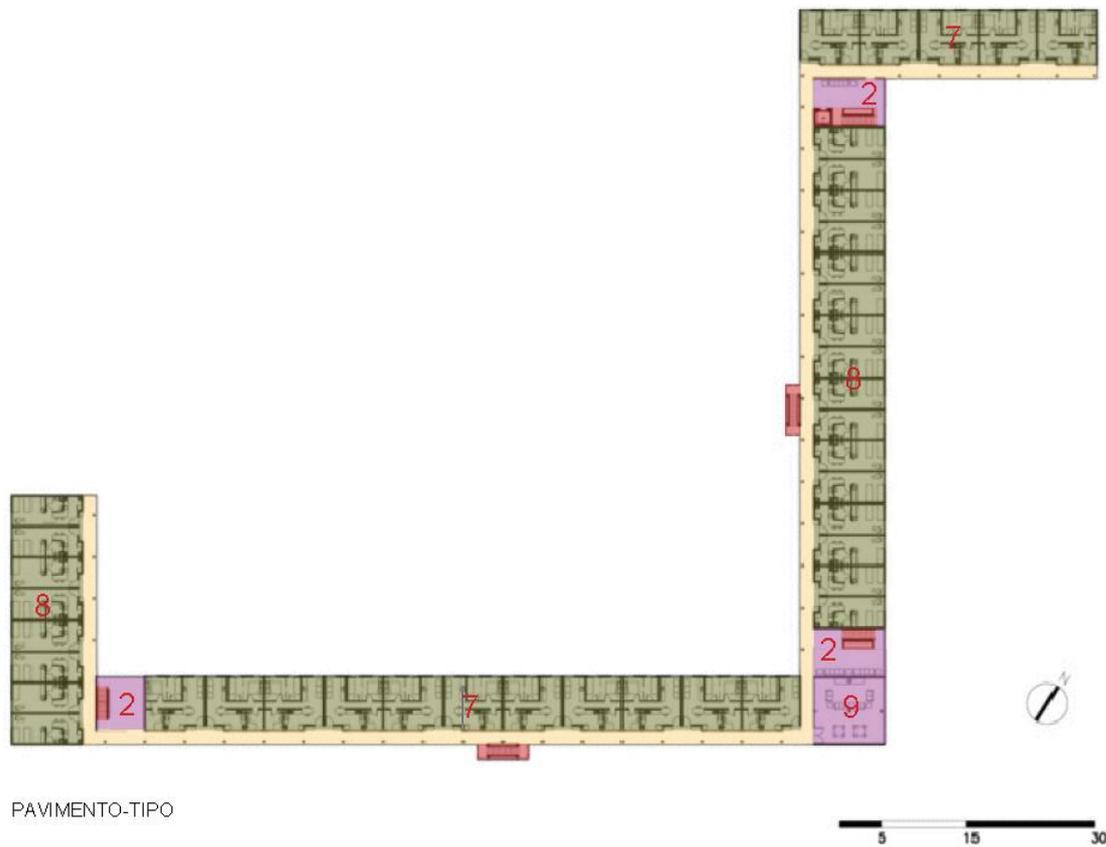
PLANTA BAIXA PAVIMENTO-TIPO – VILA DOS IDOSOS.
